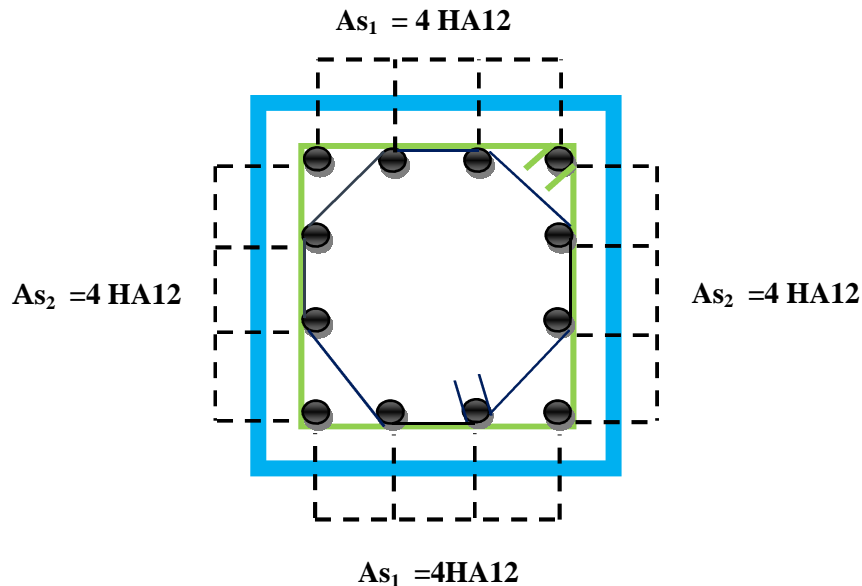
VI : Schéma ferraillage poteaux (35x35)
